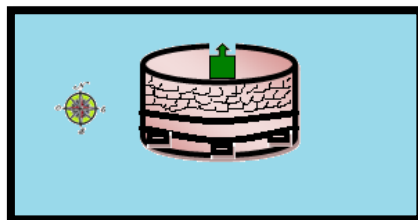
Planta del búnker con ametralladoras. Sin escala.Elaboración propia.
